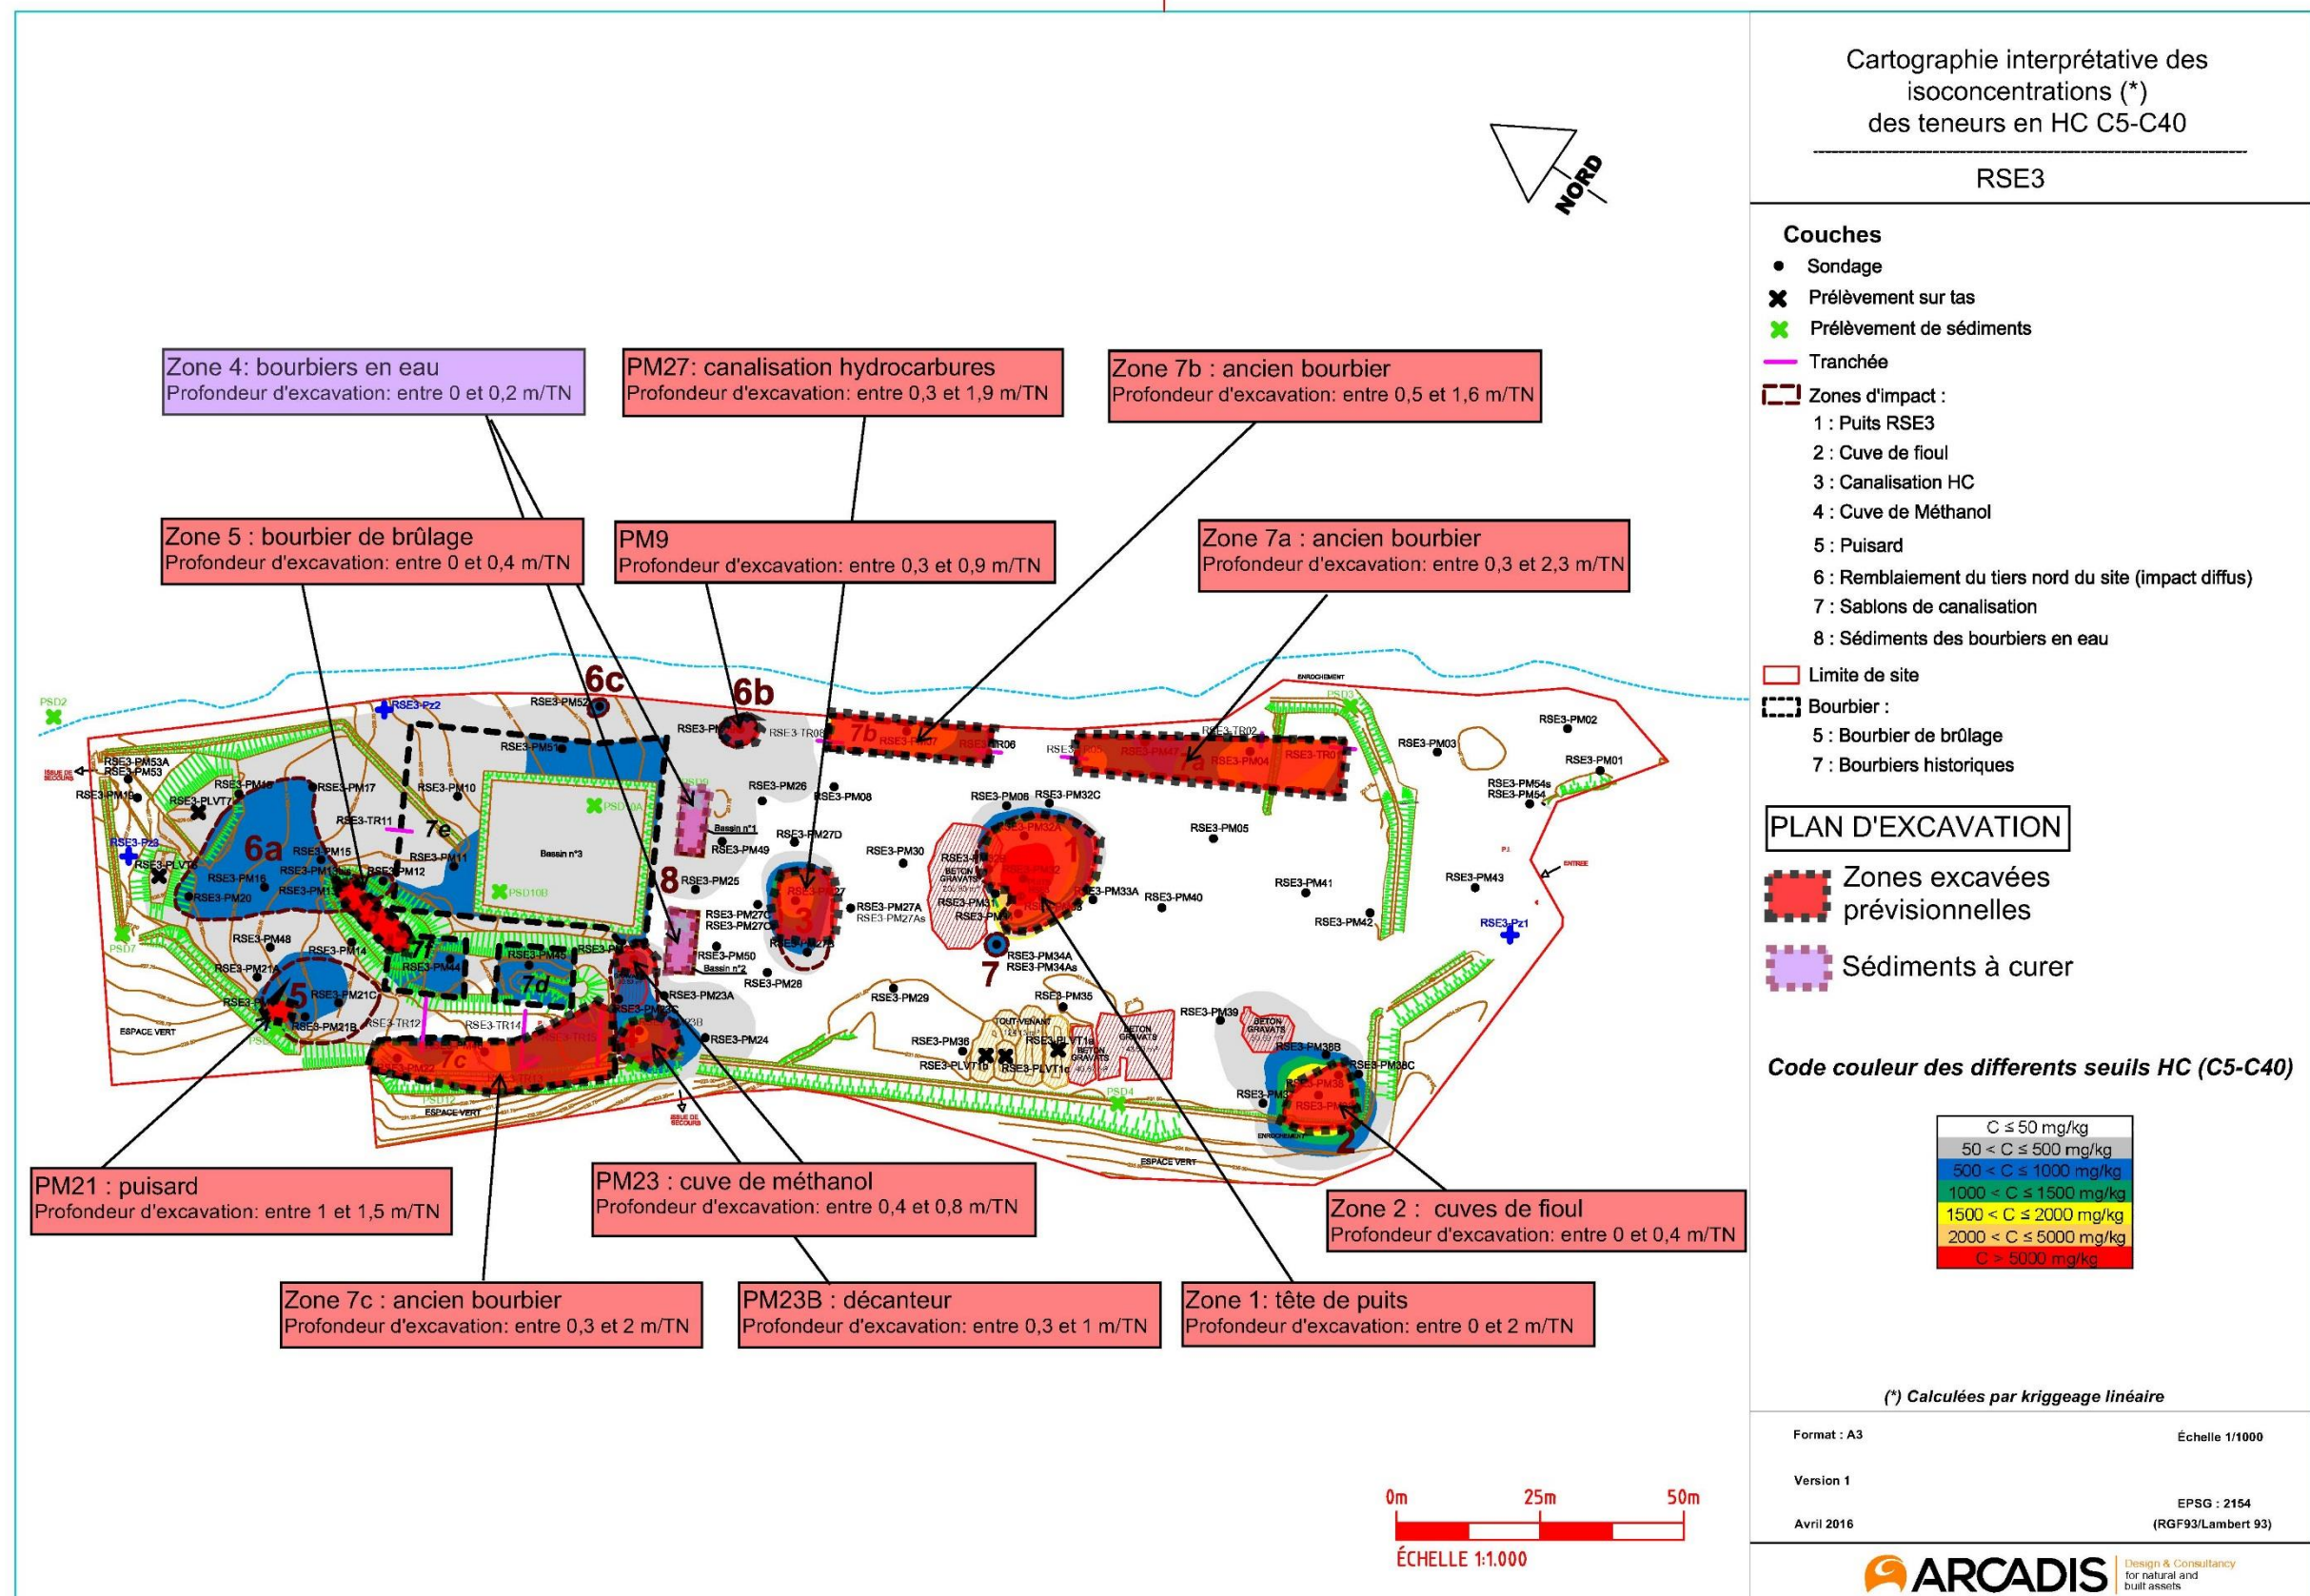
Plan d'excavation prévisionnel du site RSE3
